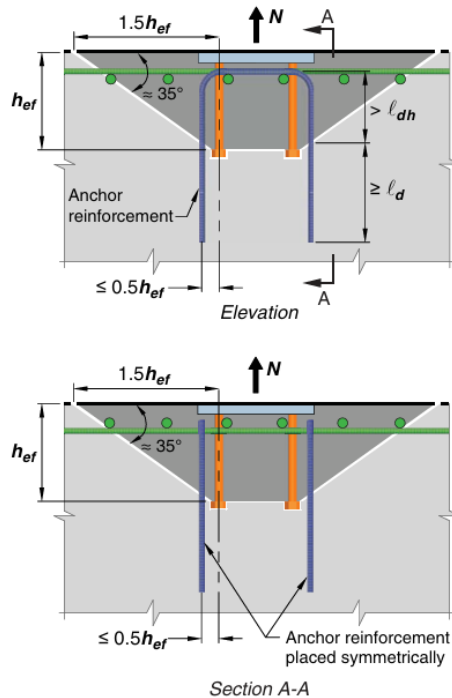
Refuerzo de anclaje para tracción. Tomado de *Building Code Requirements for Structural Concrete (ACI 318-19)*, por American Concrete Institute, 2019. Copyright 2019 por American Concrete Institute.
